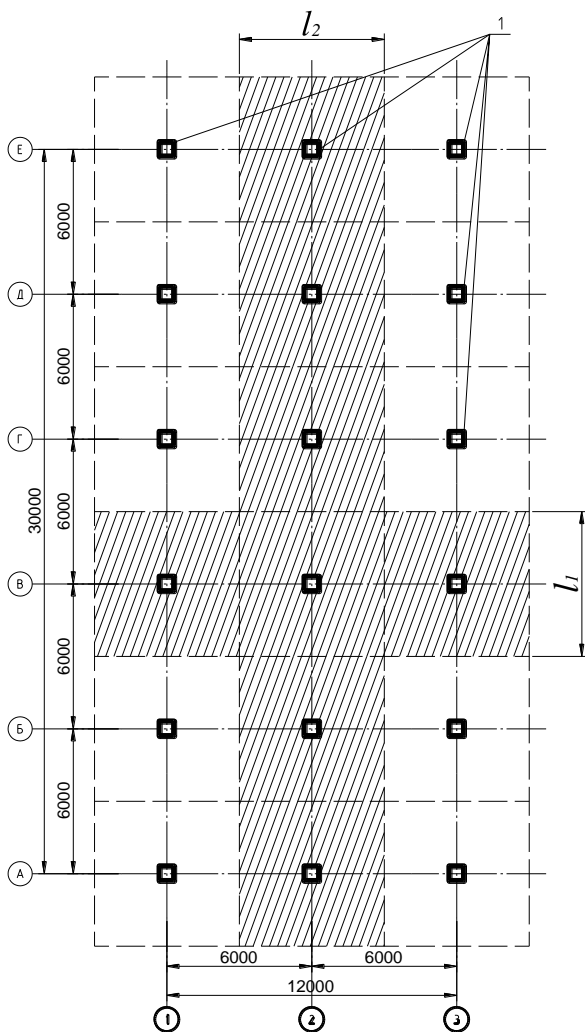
Разделение плиты-ростверка на заменяющие балки:
